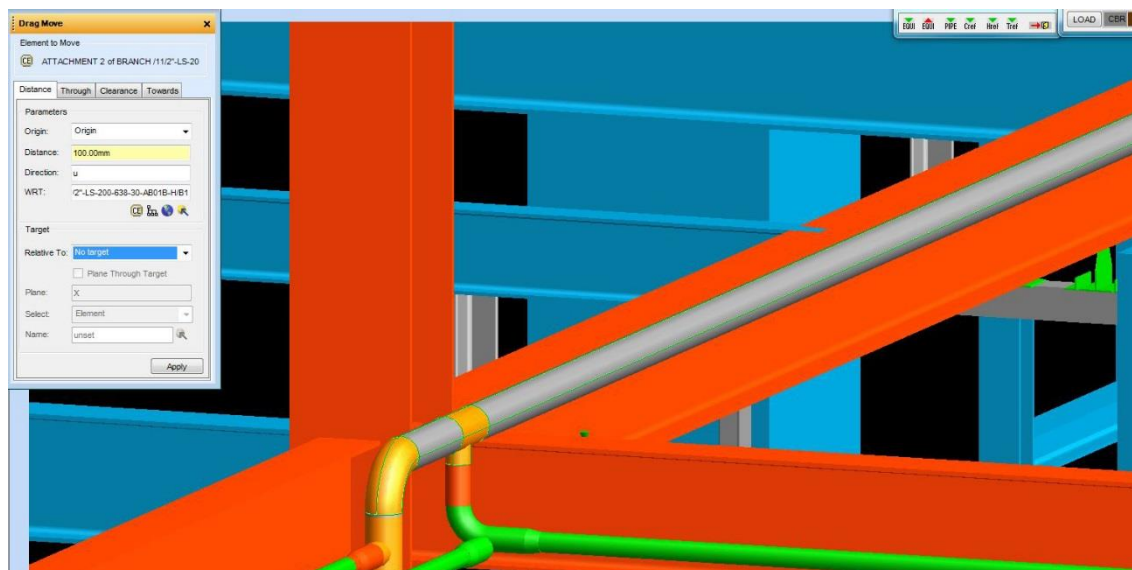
Kolize potrubí s nosnou konstrukcí
